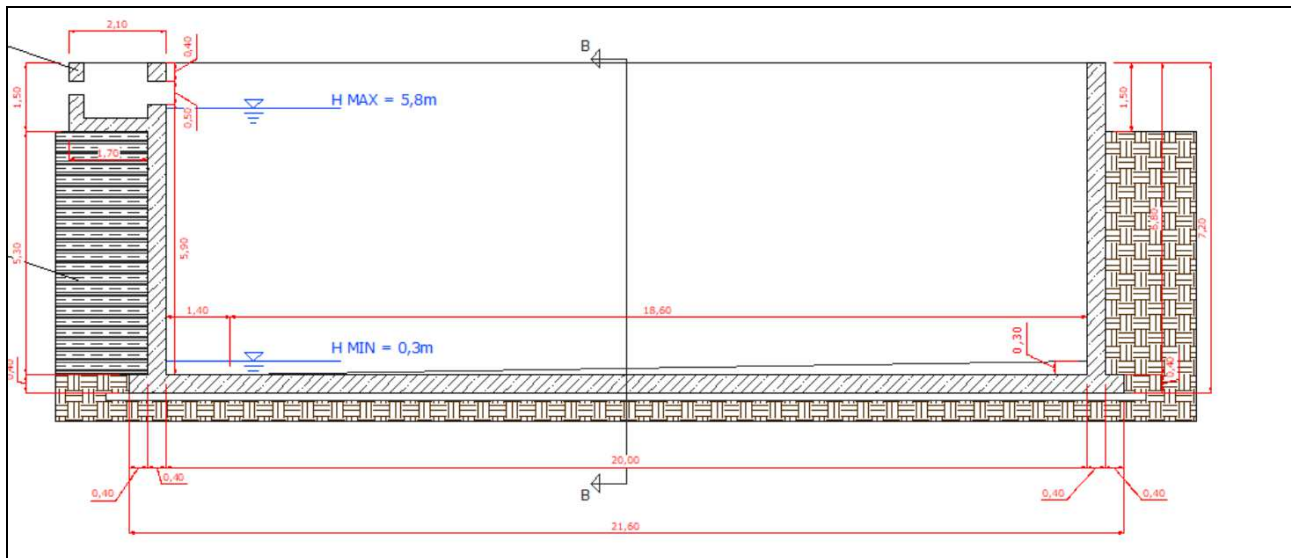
Sezione tipo Nuova vasca in calcestruzzo – Architettonico
